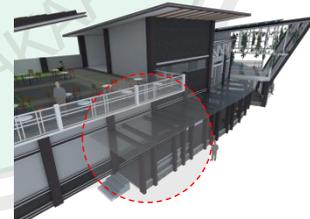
Tampak depan bangunan *resto and cafe
